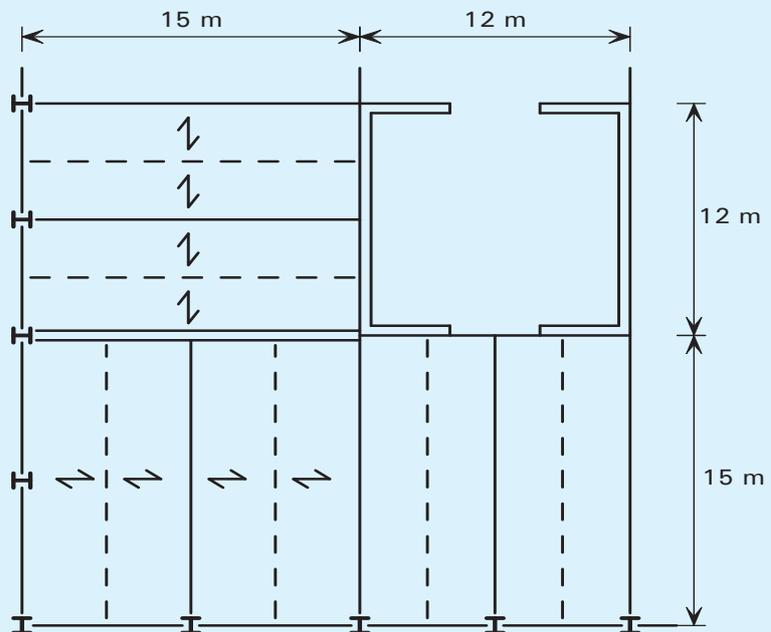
Типовая схема расположения балок вокруг железобетонного ядра жесткости
